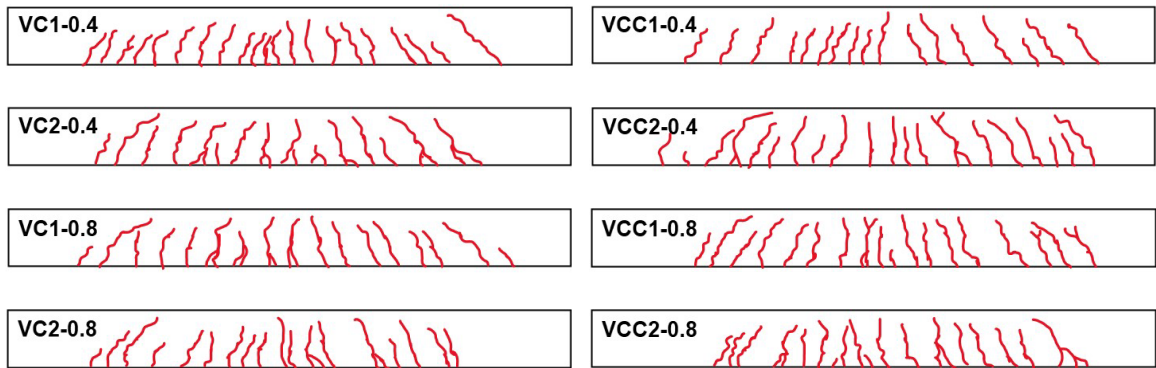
Patrones de agrietamiento final de las vigas
